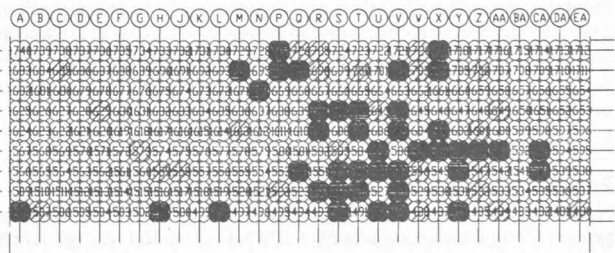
plan de la zone d'essais : disposition des colonnes.
